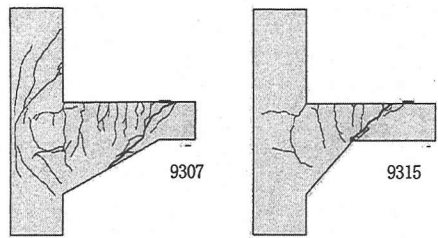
TYPE-II ①試験体のひび割れ発生状況
